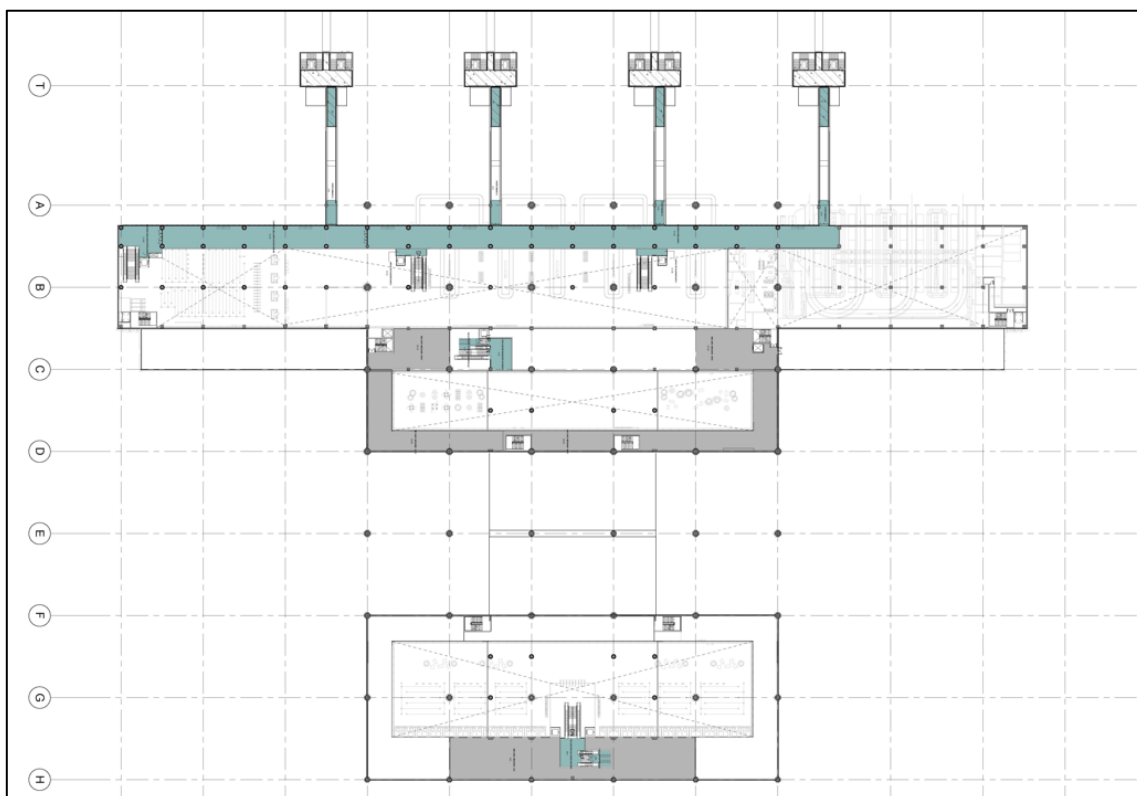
| Planimetria Piano Mezzanino 2026 – Zoning delle aree
